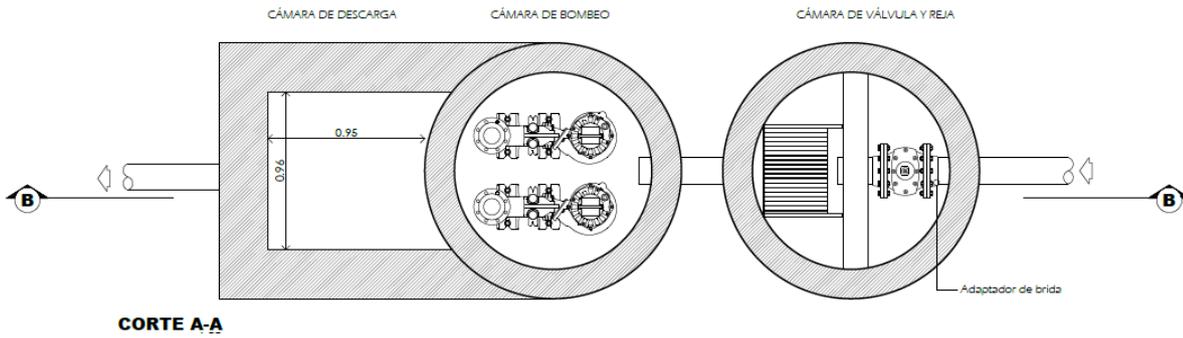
Vista en planta de pozo de bombeo cloacal
